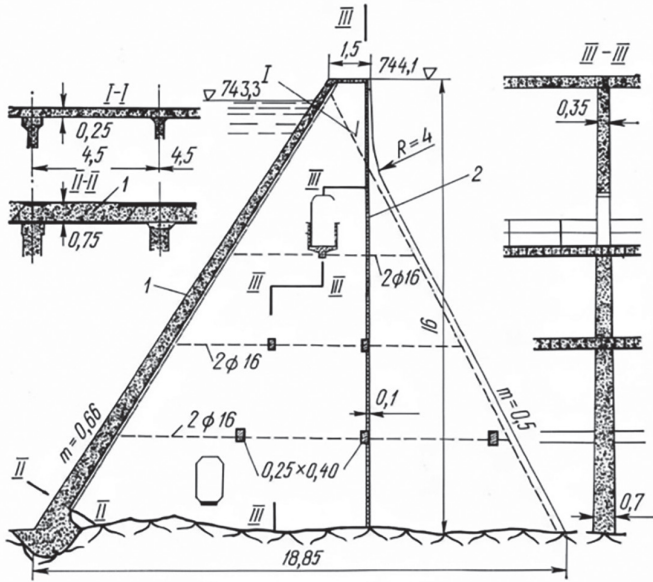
Sección transversal y vista de una presa de contrafuertes.
